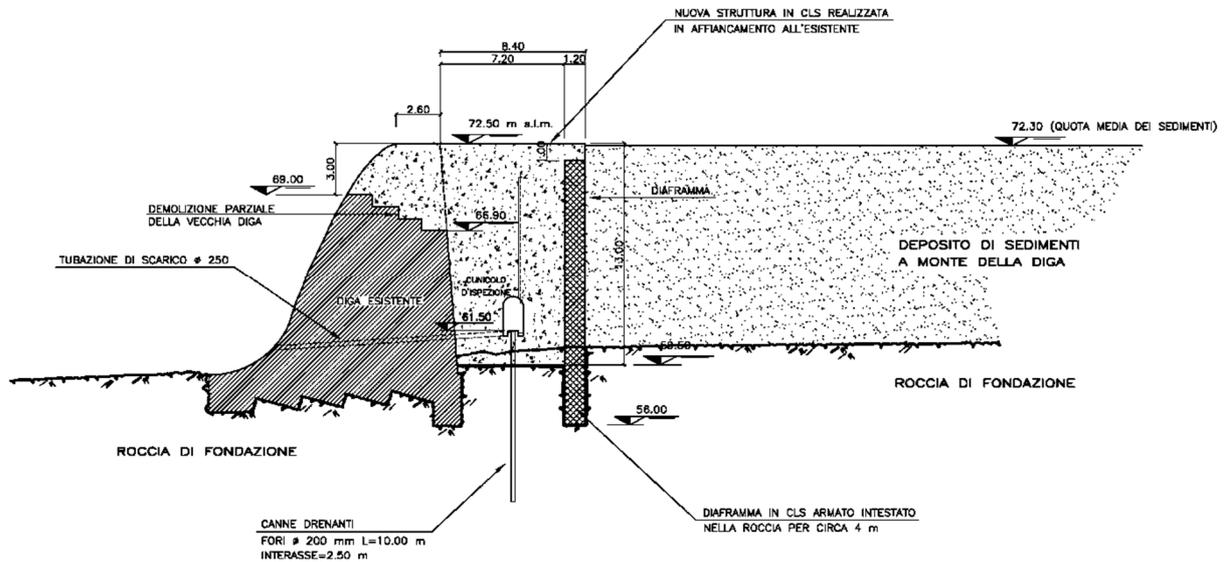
Schema degli interventi in progetto - Sezione
